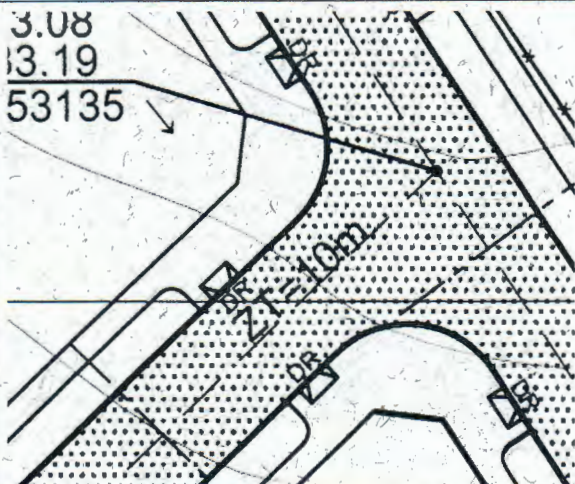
Acera proyectada en intersección calle Hernán Aravena con calle 5, según lámina 1 de 10 del plano "Planta de Pavimentación".
